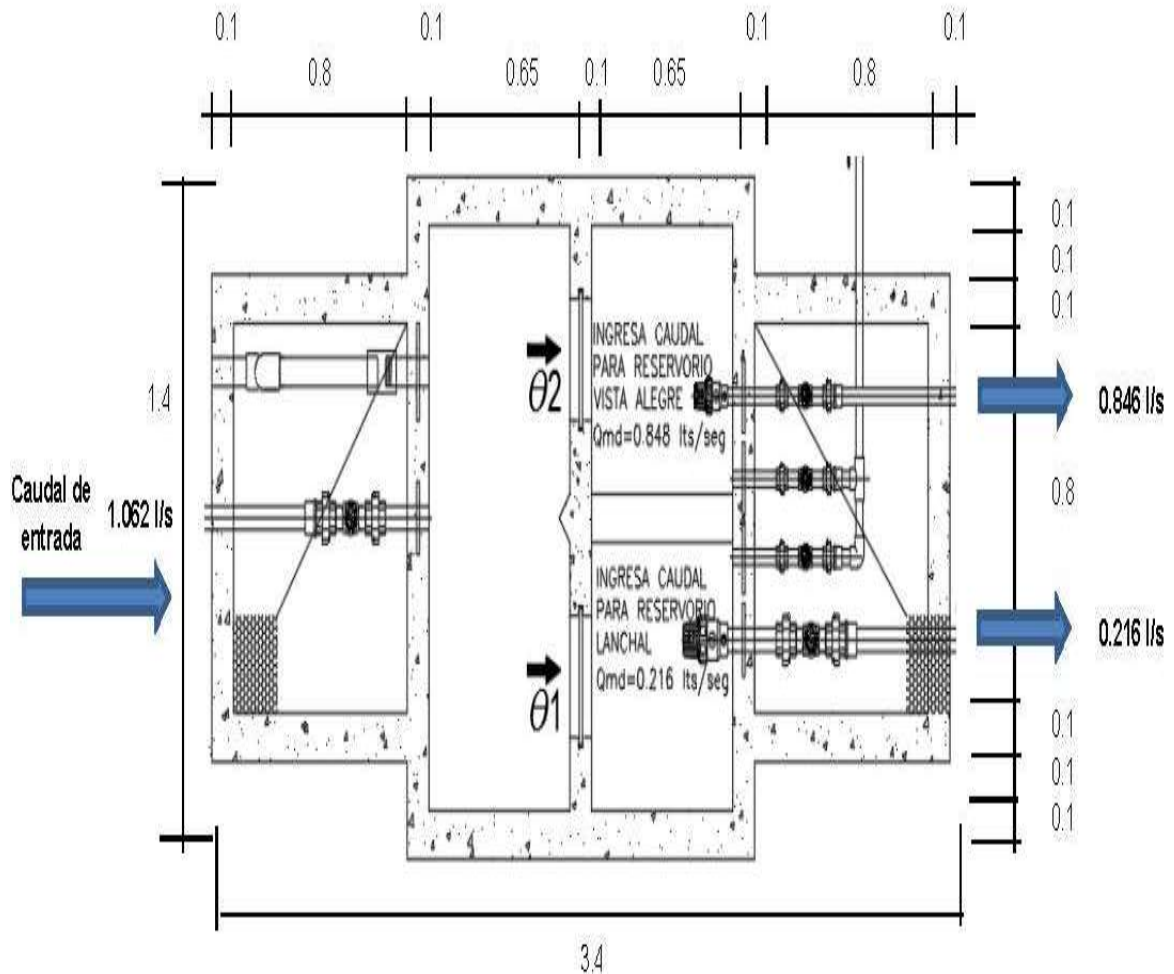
Vista en planta de la Cámara Distribuidora de Caudales
